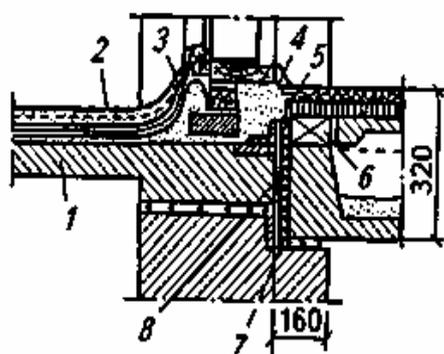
Сопряжение балконной плиты с наружной стеной: 1 – балконная плита; 2 – цементный раствор; 3 – подкладка; 4 – утеплитель; 5 – закладной металлический элемент; 6 – прокладка; 7 – утеплитель; 8 – анкер
